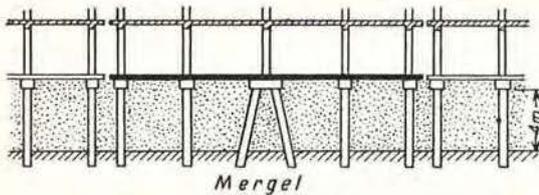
Coupe verticale suivant une ligne de pilotis.
